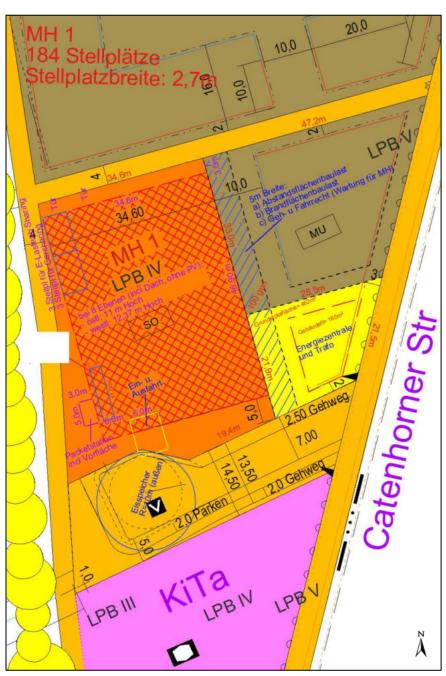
Lageplan zu MH 1 "Catenhorner Straße" /11/
